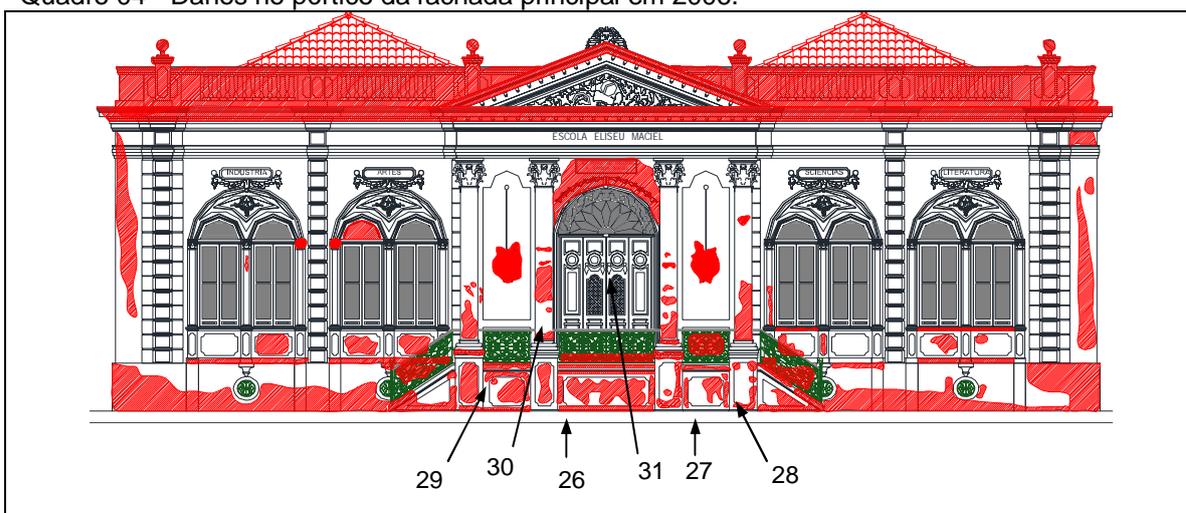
Fachada principal – Indicação dos danos no pórtico em 2006.
